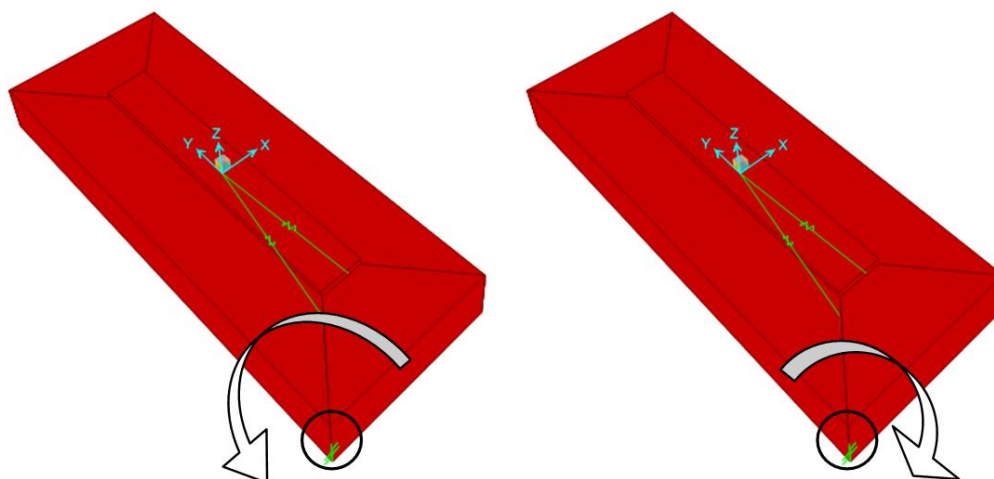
Zattera di fondazione: cinematico di ribaltamento
